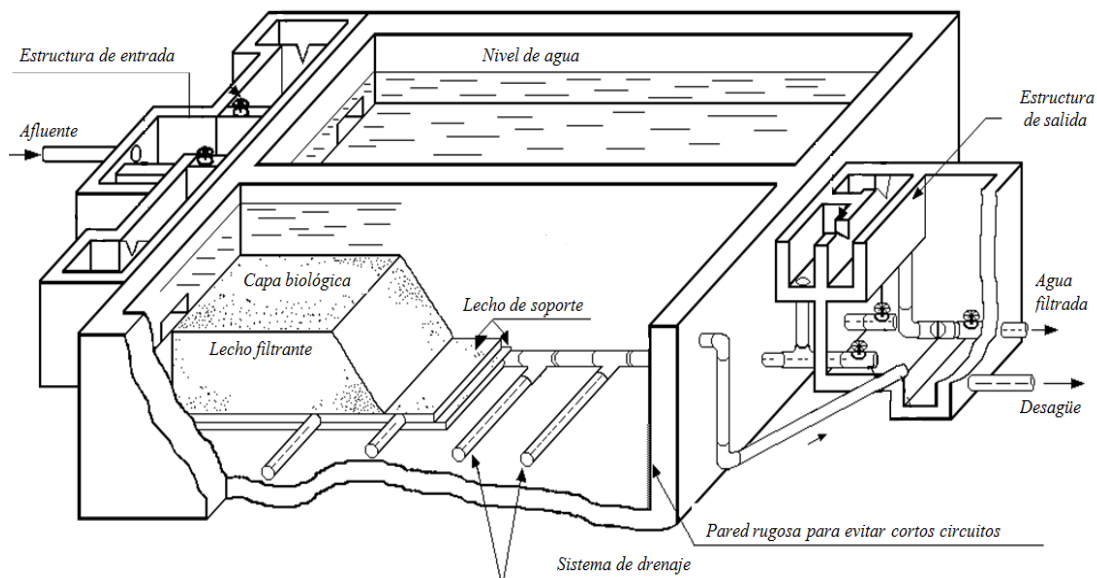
Planta de filtración lenta propuesta para la evaluación económica.
